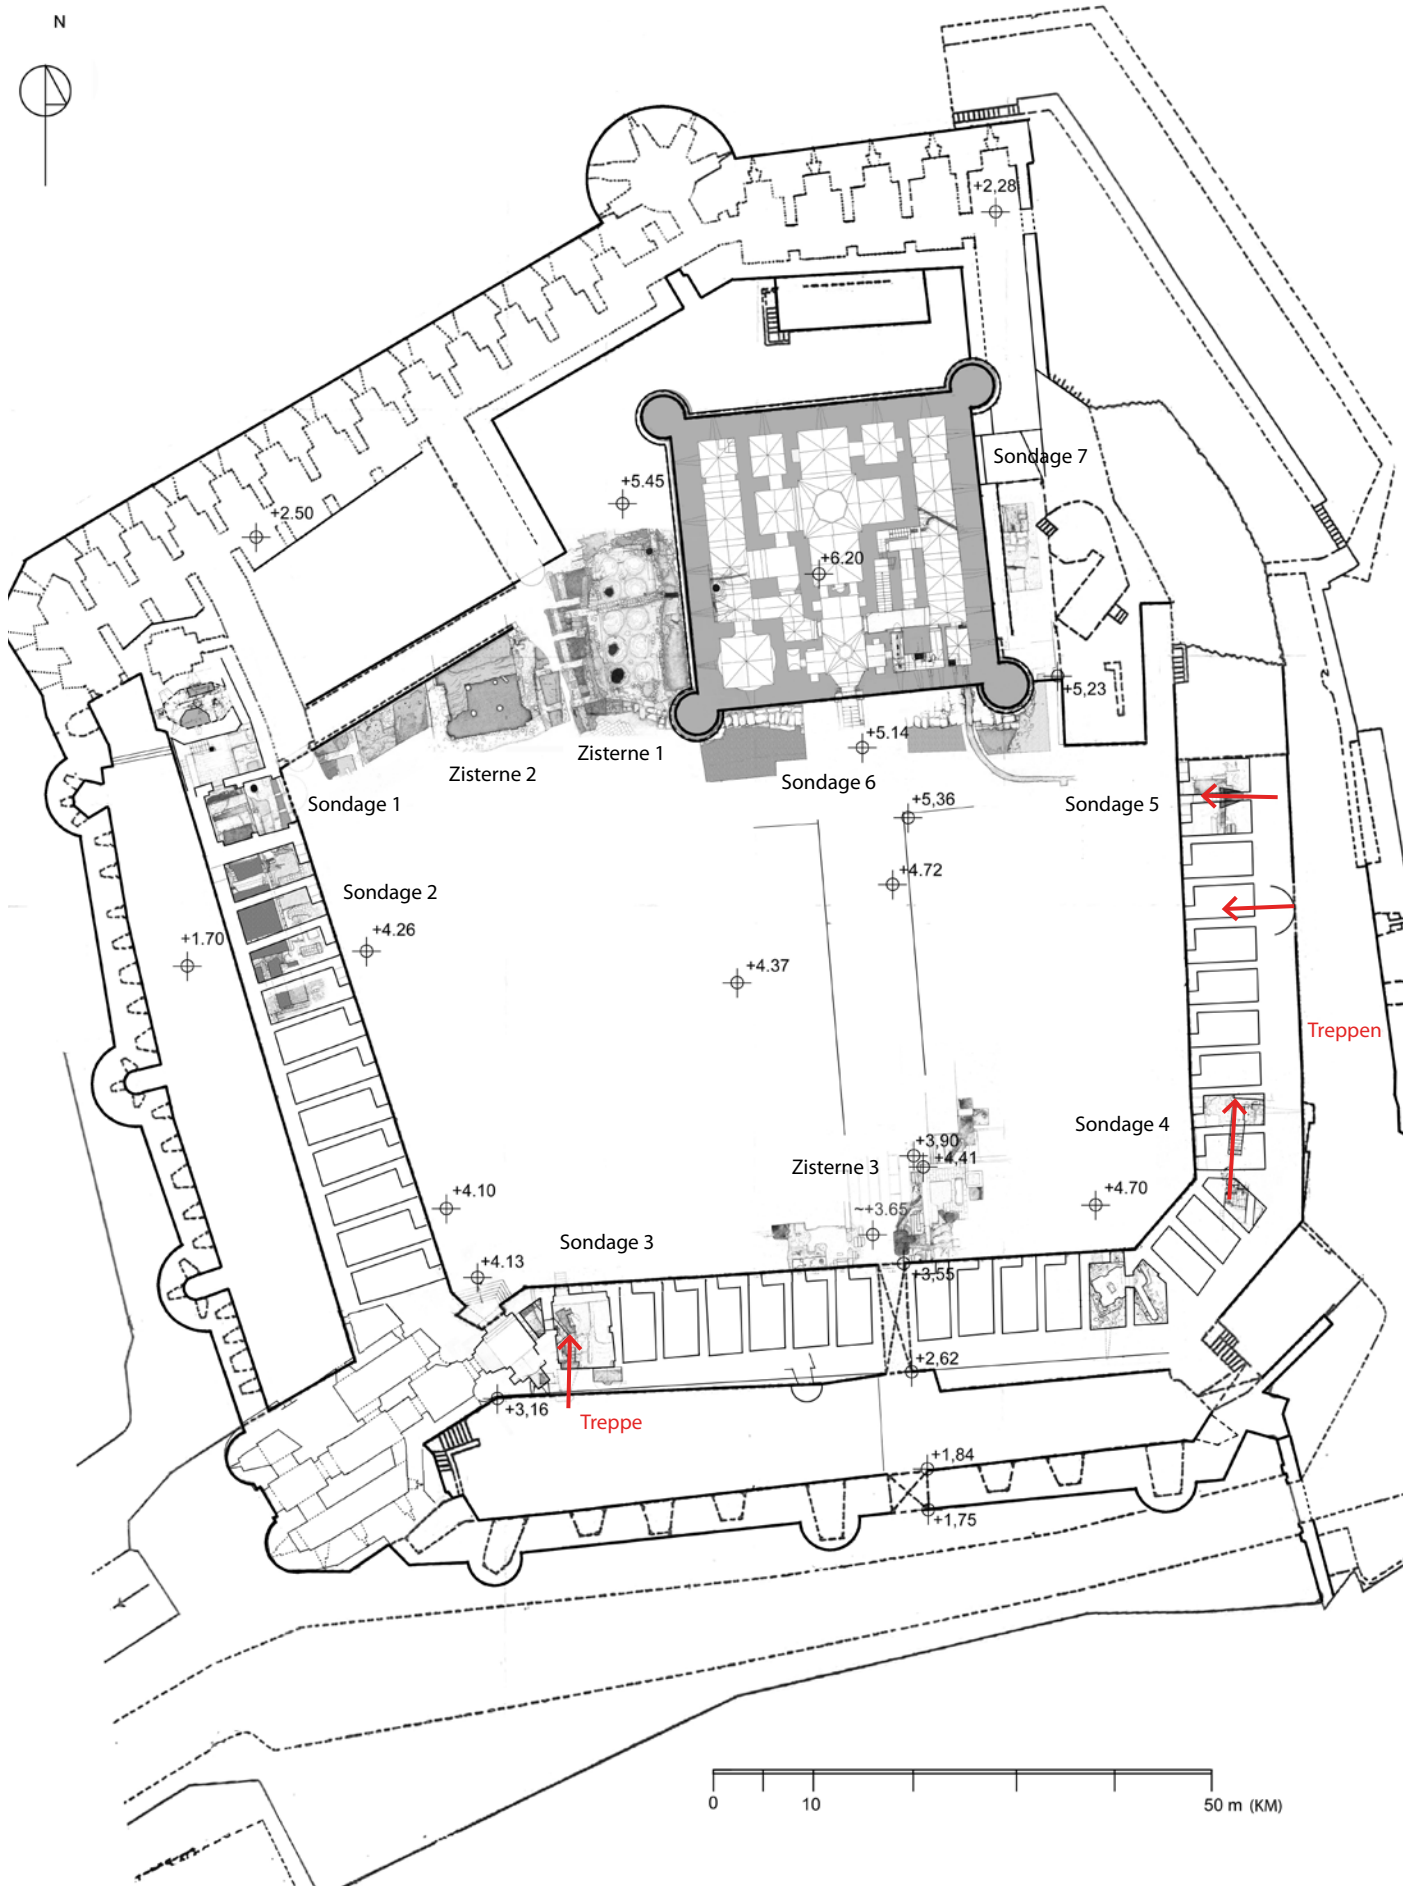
Geländeplan mit Lage der Grabungsstellen.
